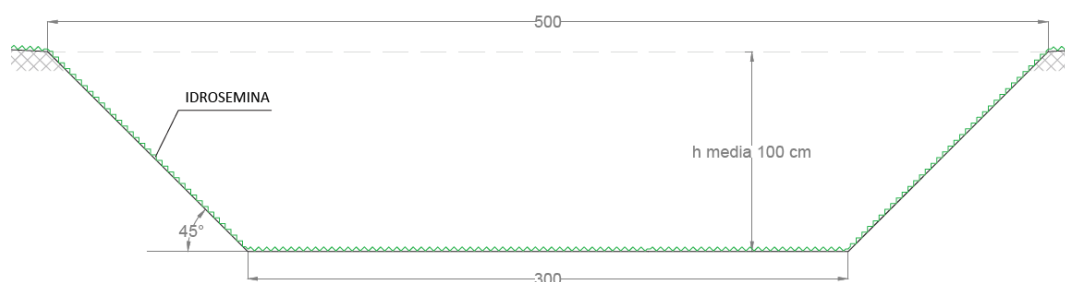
Sezione trasversale tipo del canale progettato in corrispondenza dell'impluvio naturale
